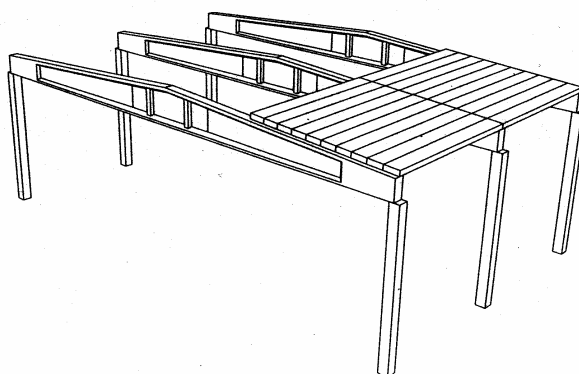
Traves aporticadas apoiando a cobertura e os elementos de fachada, distantes entre si entre 5 e 12 m.
